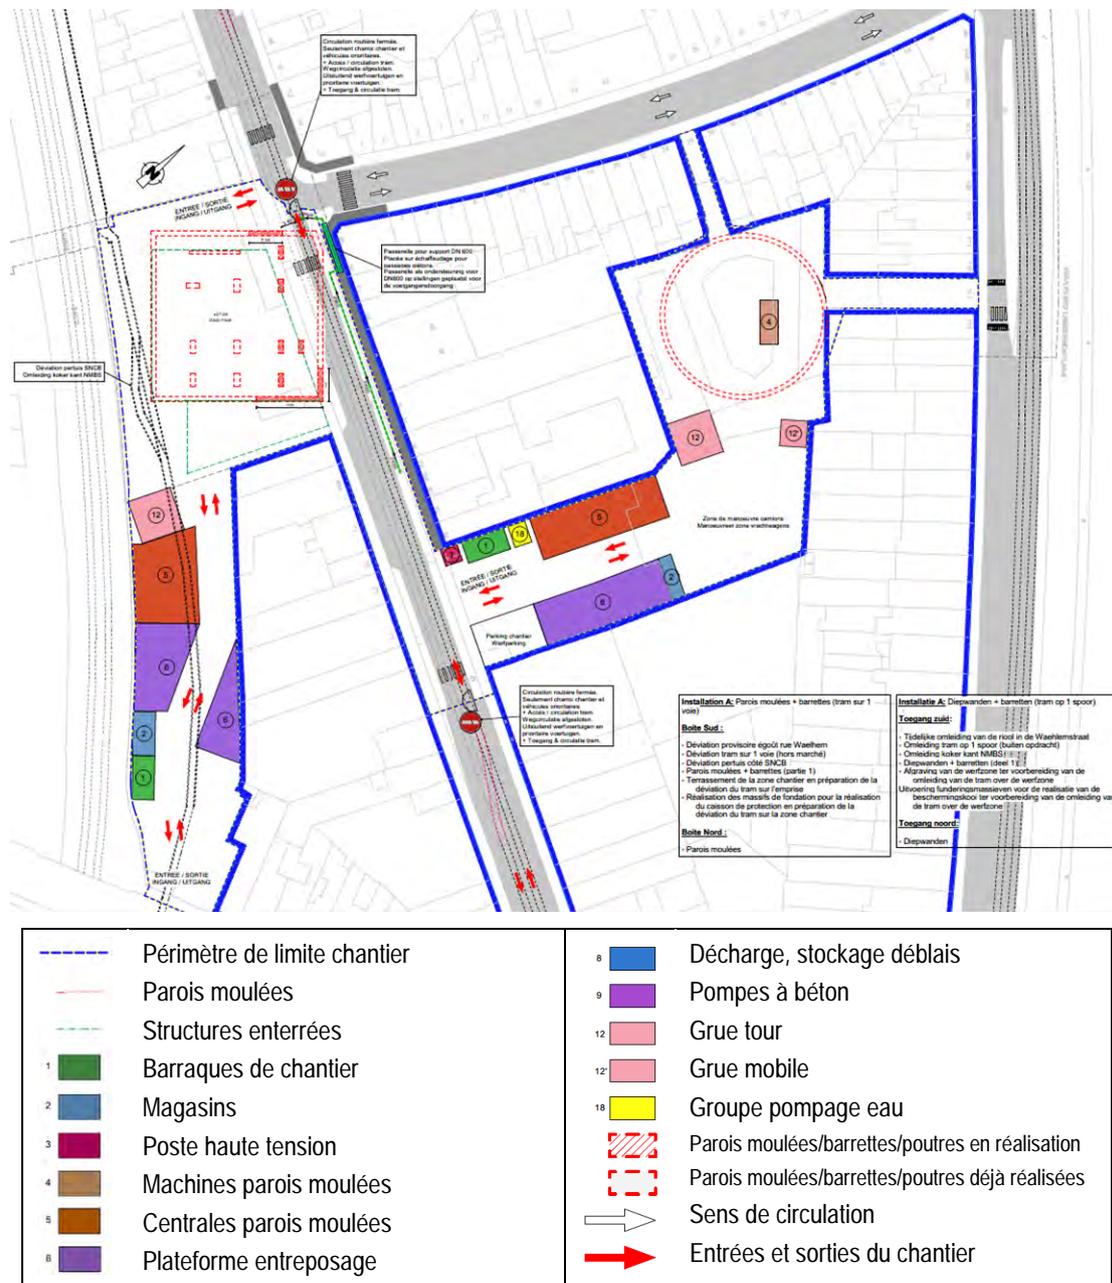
Plan de la phase A des installations de chantier (BMN, 2019)
